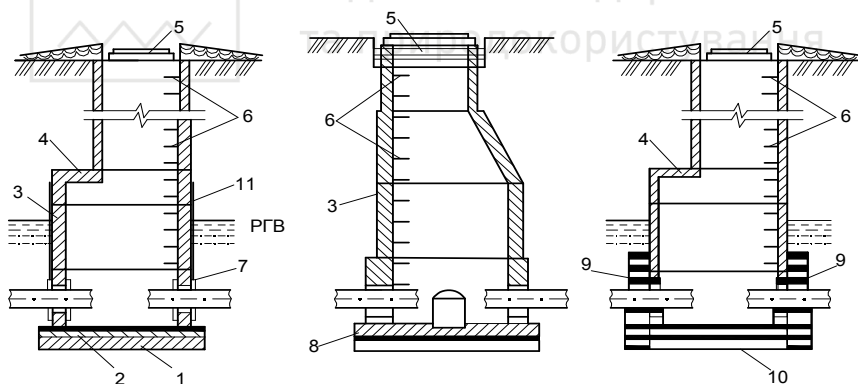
Збірний круглий (а, б) і прямокутний (в) залізобетонні колодязі, що влаштовуються в ґрунтах:
